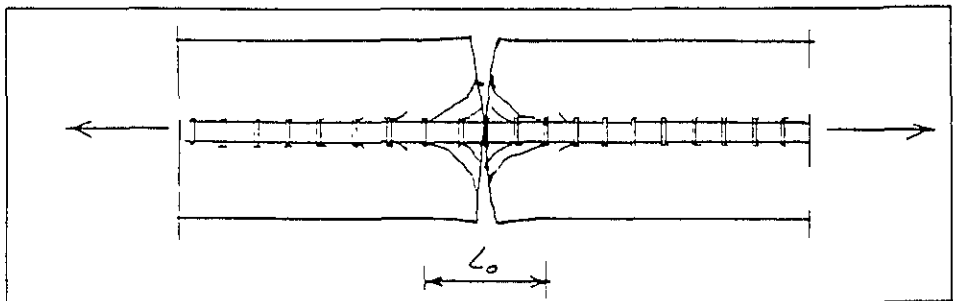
Distancia del deslizamiento, l_0 en la grieta
